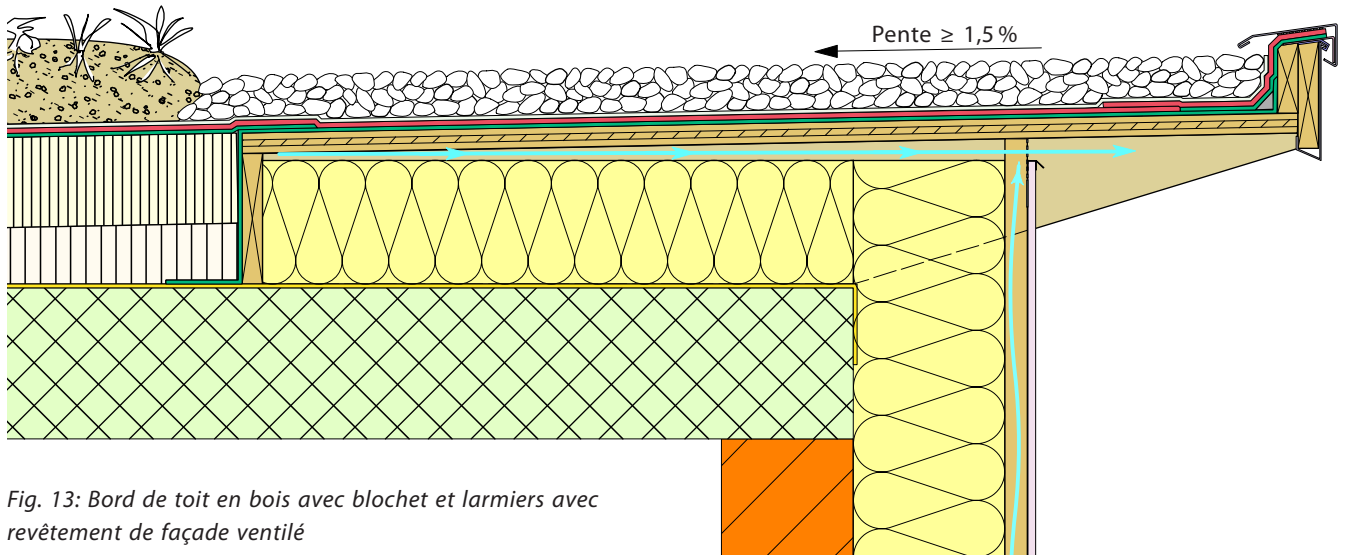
Bord de toit en bois avec blochet et larmiers avec revêtement de façade ventilé
